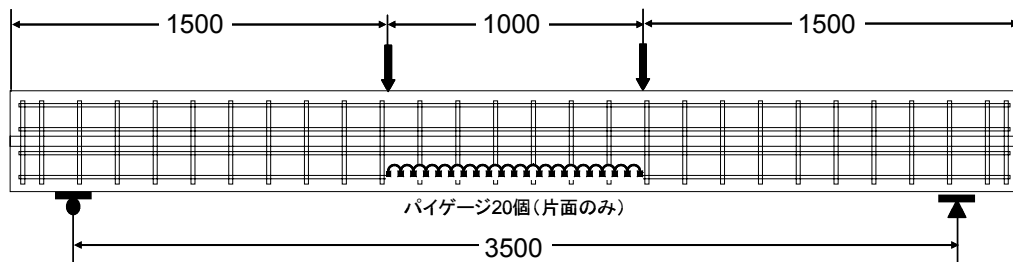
鉄筋配置図および荷重試験方法 (単位: mm, 帯鉄筋の純かぶりはいずれも 35mm)
